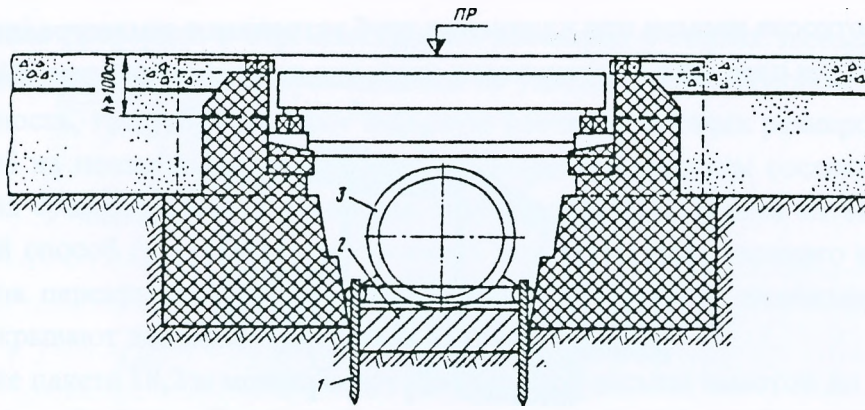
Замена малого балочного моста трубой: 1 – шпунтовое ограждение; 2 – фундамент трубы; 3 – труба.
